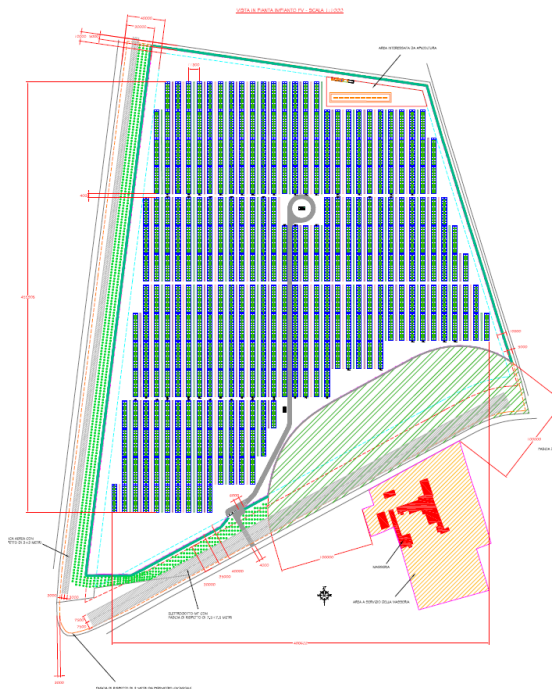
Planimetria del layout dell'impianto – cfr.estratto da elab STN.
